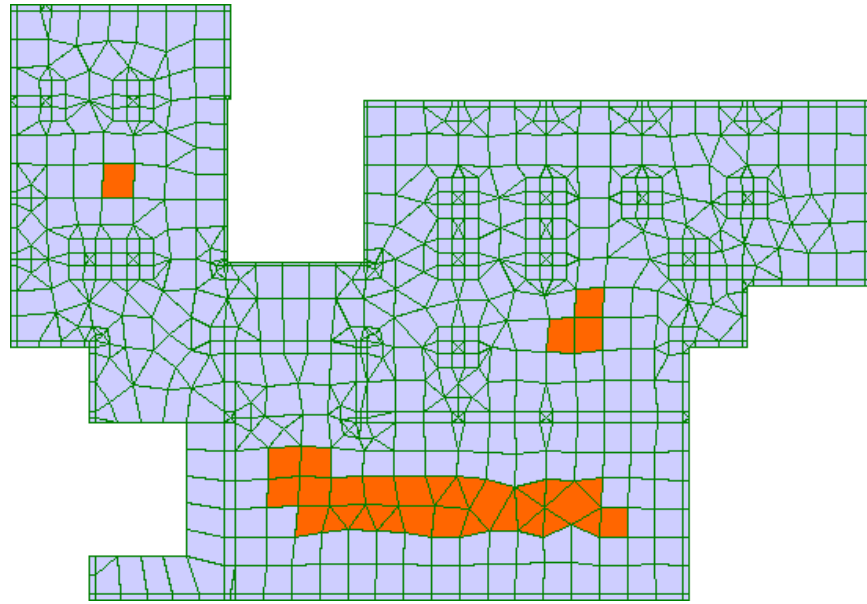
Армування плити перекриття над укриттям для нижньої грані по осі Y
